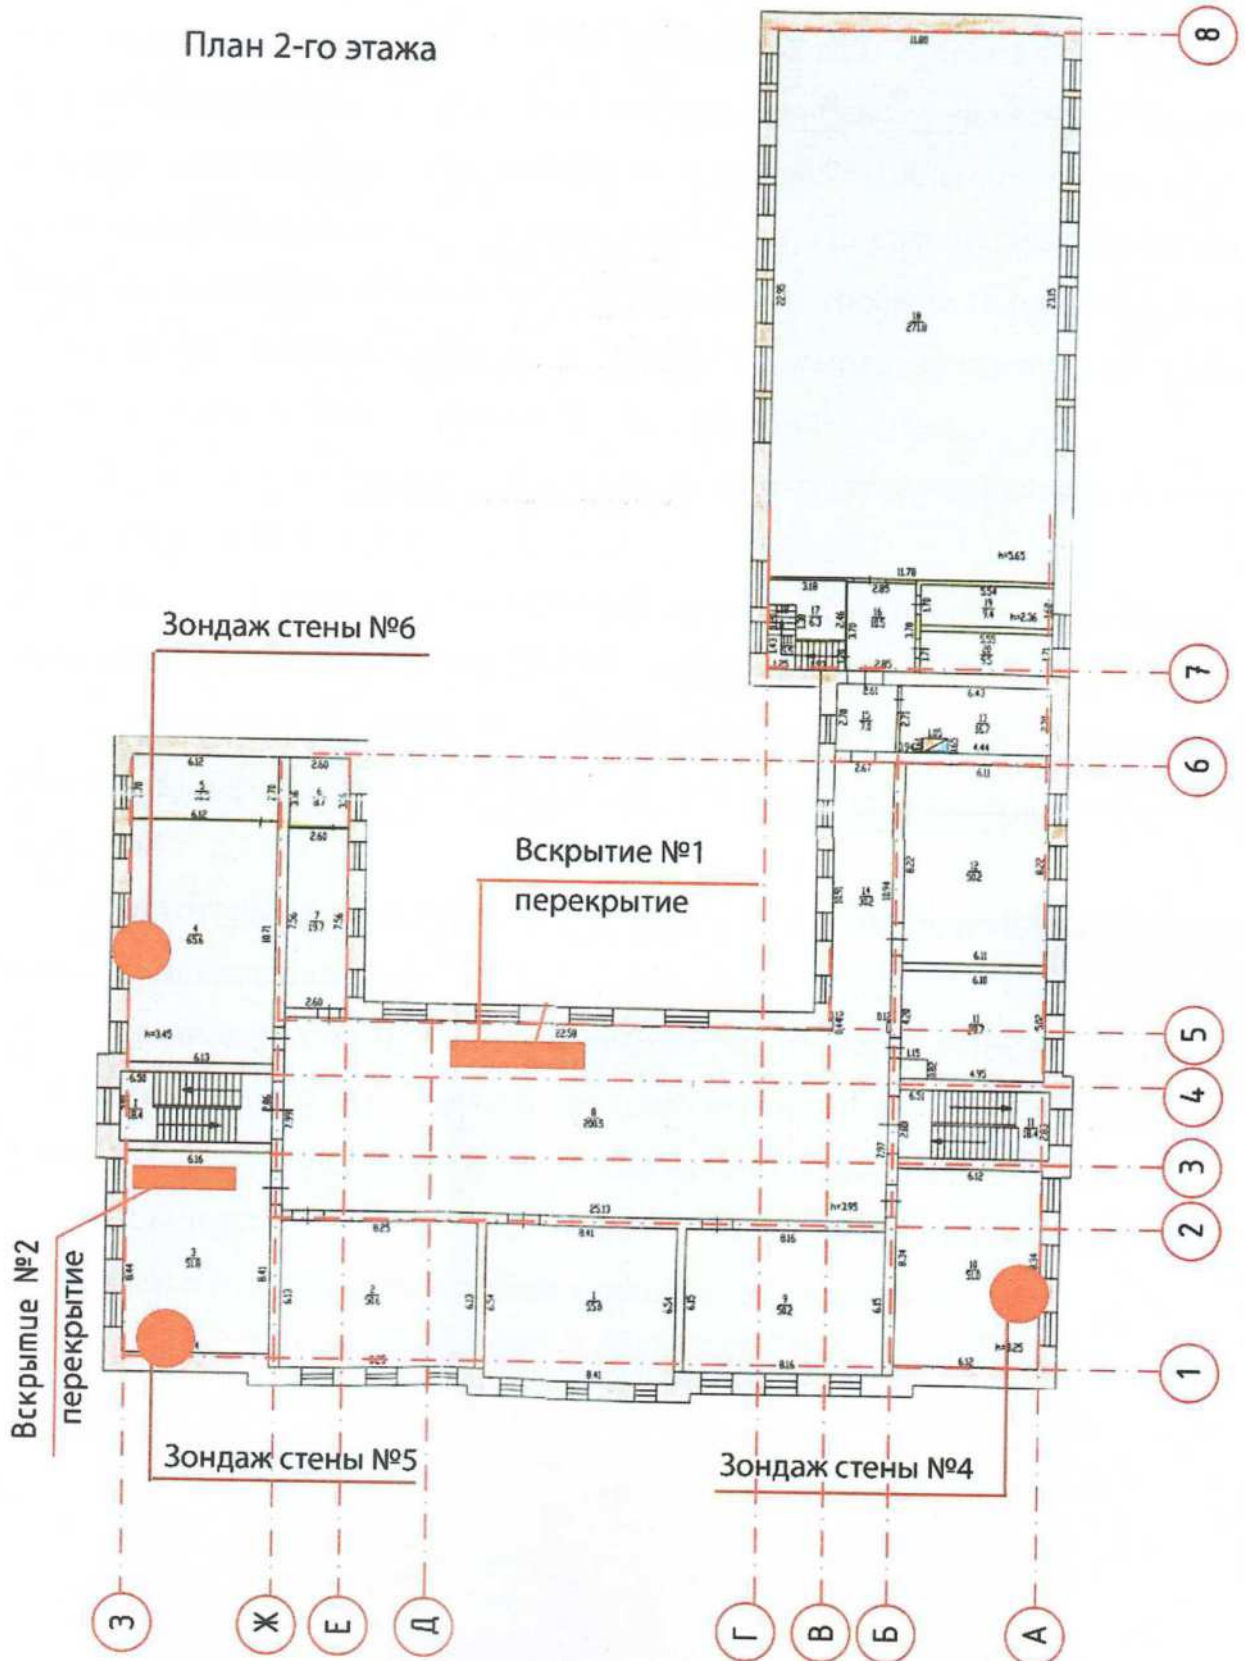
Местоположение вскрытий перекрытия 1-го этажа и зондажей наружных стен на плане 2-го этажа.
